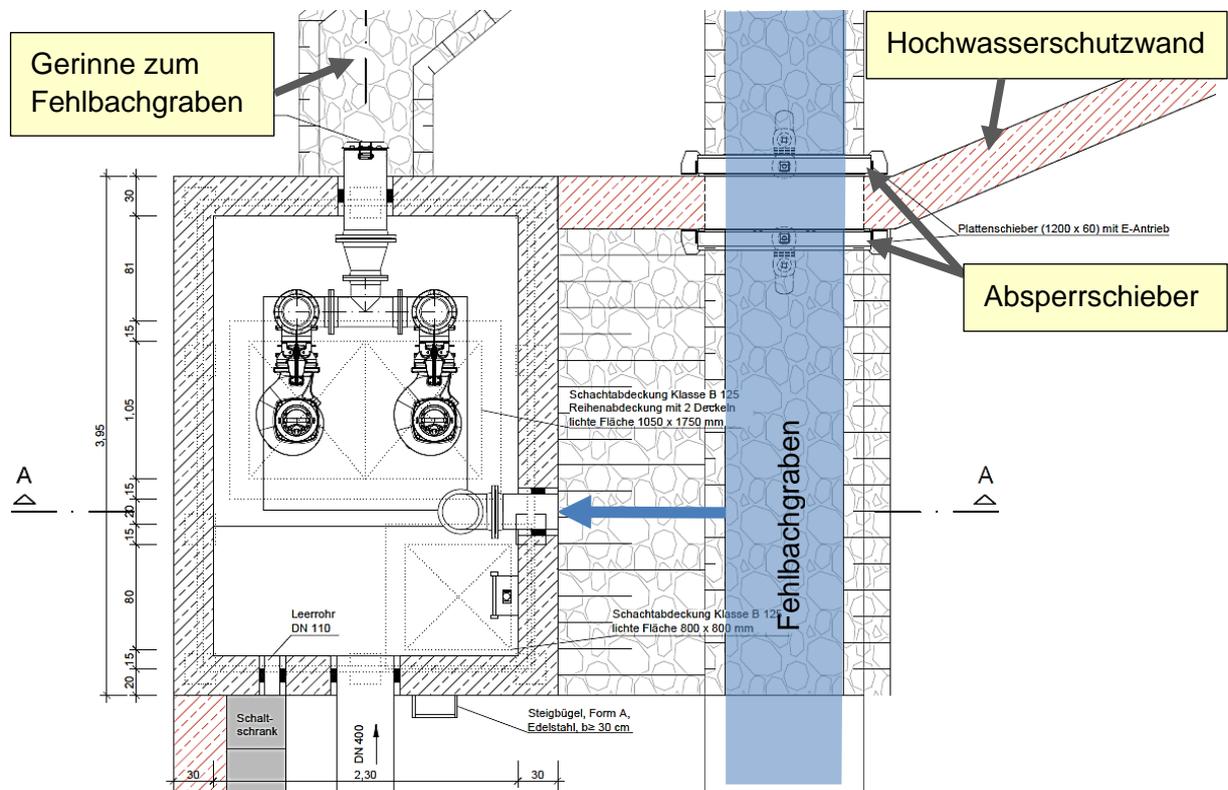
Grundriss Pumpwerks 3
